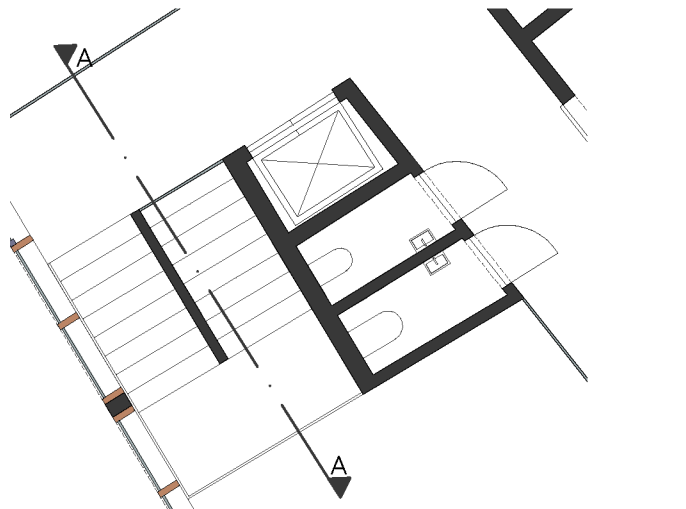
Grundriss Obergeschoss Erschließungskern 1:100
